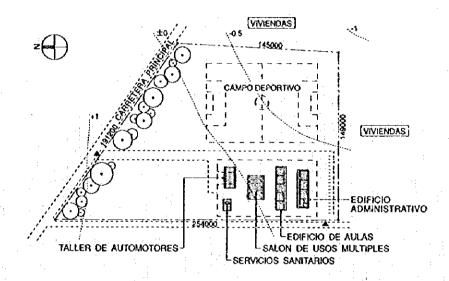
PLAN GENERAL DE DISPOSICION DEL INSTITUTO NACIONAL DE PUERTO EL TRIUNFO
